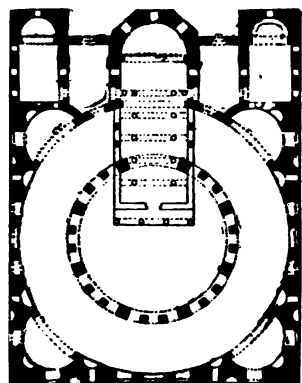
Grundriss der Kathedrale zu Bosra.
